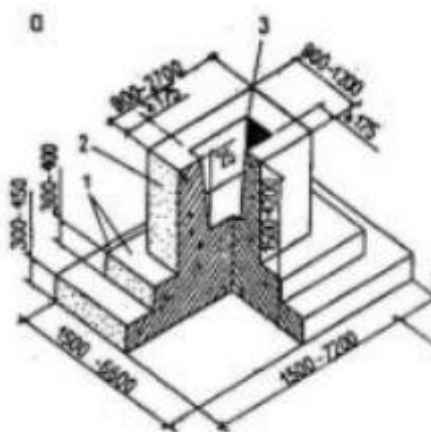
Монолітний стовповий залізобетонний фундамент, стаканного типу
